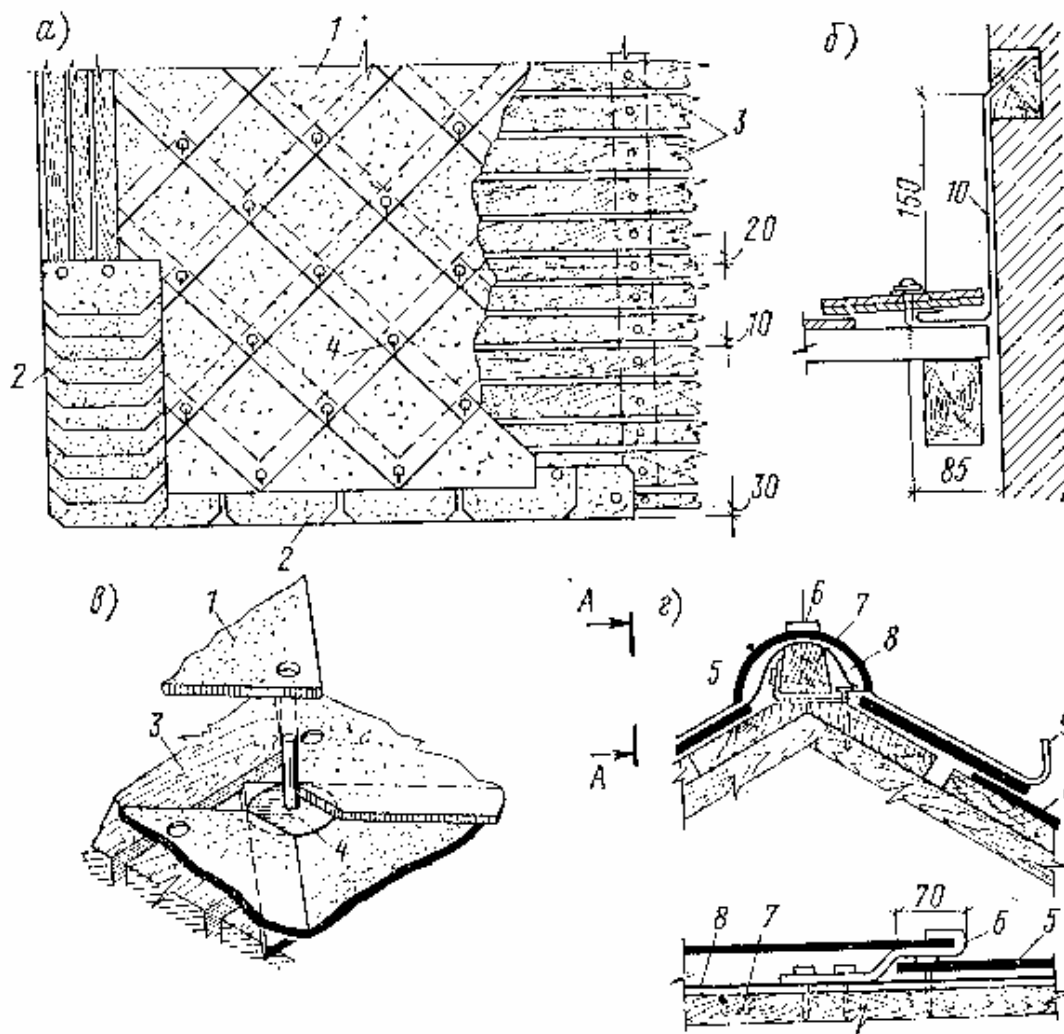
Кровля из плоских асбестоцементных плиток:
